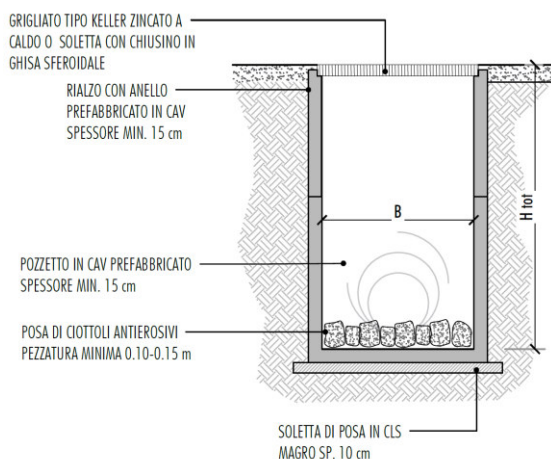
MANUFATTO D'IMBOCCO/SBOCCO TIPO 1
